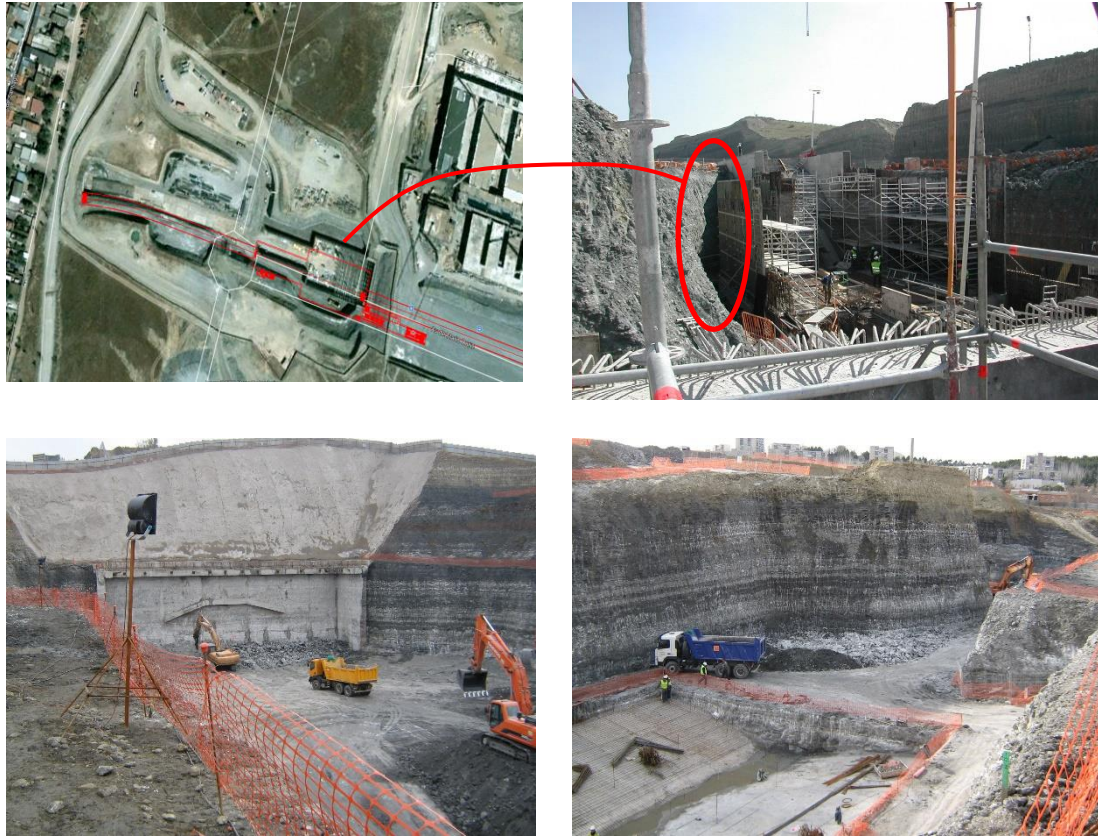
Planta y fotos de la excavación durante la fase de obra
